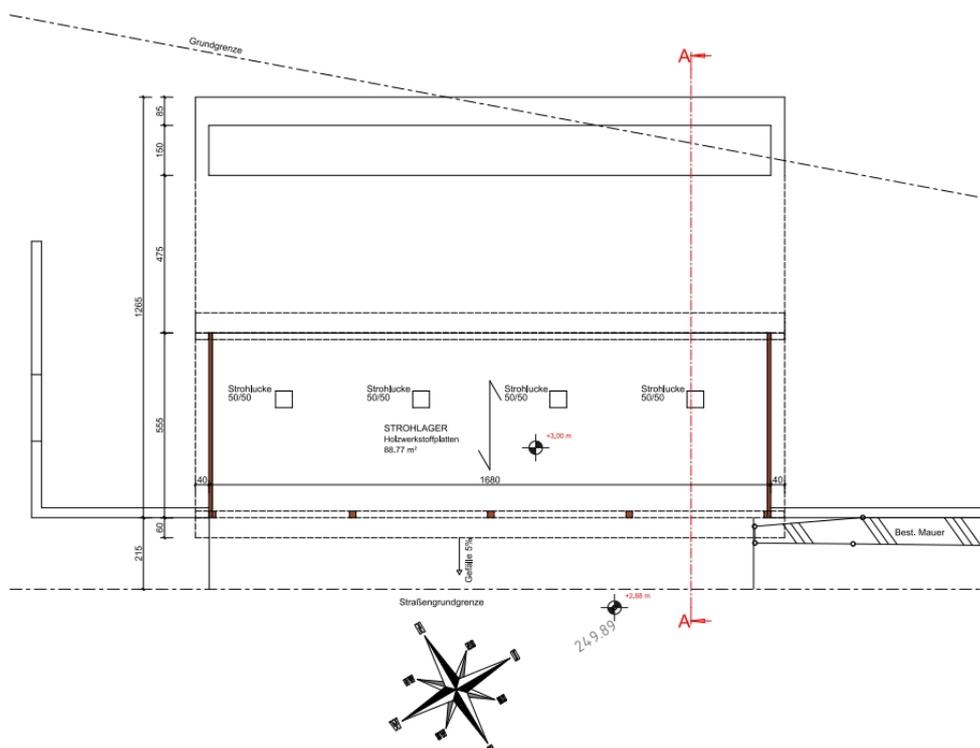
Grundriss Stallgebäude OG, Planungsbüro Schatz KG
